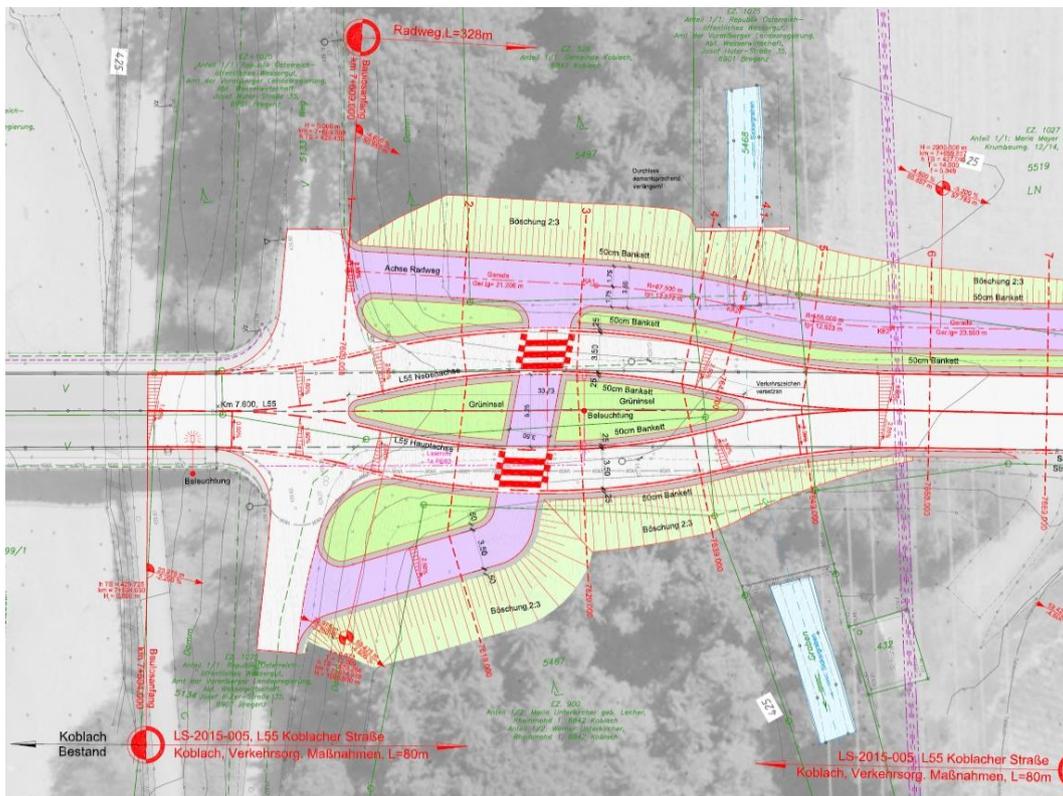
Planausschnitt Torsituation/Querung L55 – Frutzbrücke (Dr. Brugger + Partner)
